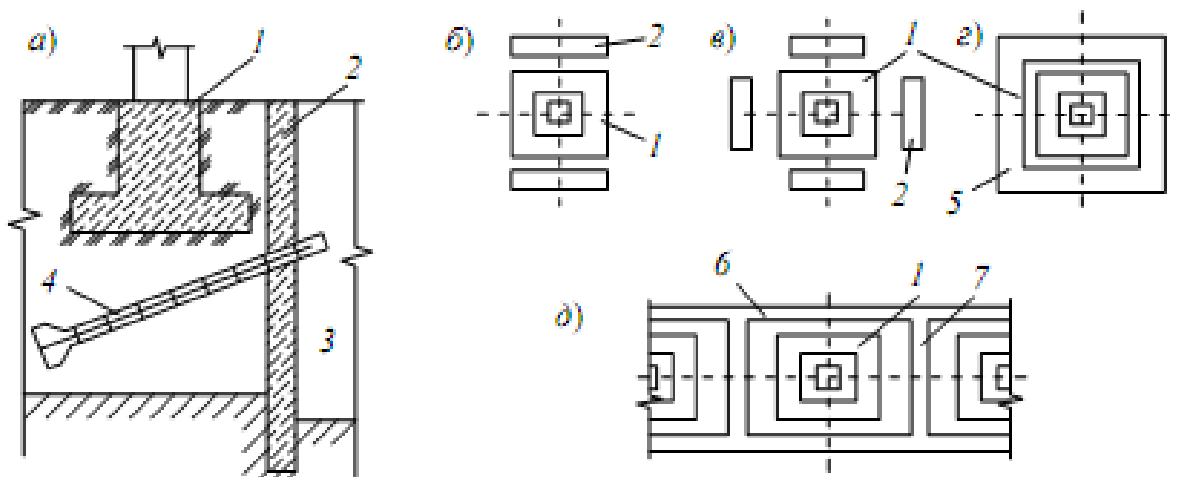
Схеми посилення фундаментів способом «стіна в ґрунті»:
